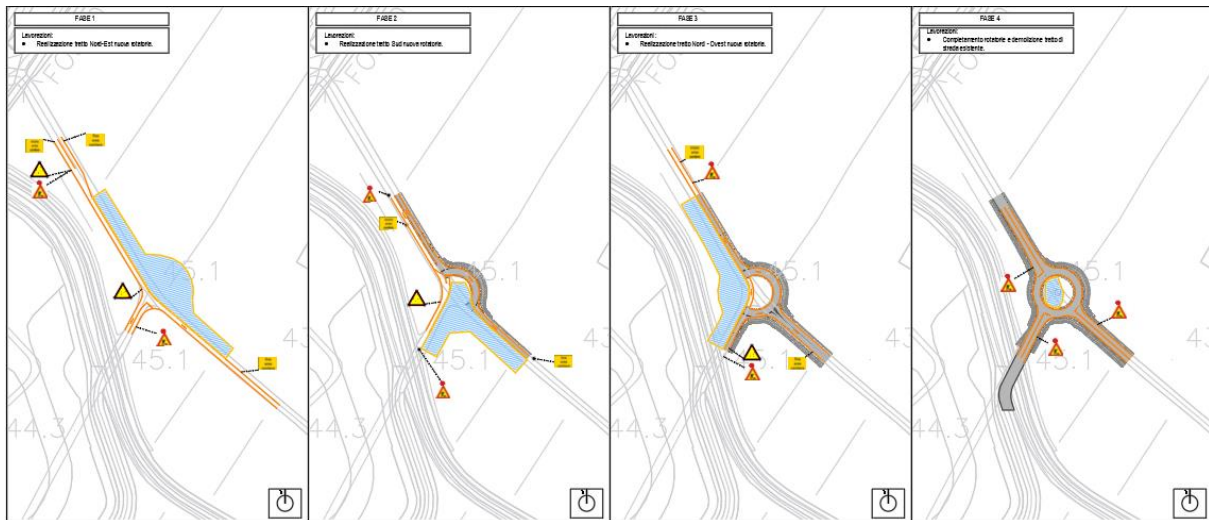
Fasi di cantierizzazione nodi viari D e E
